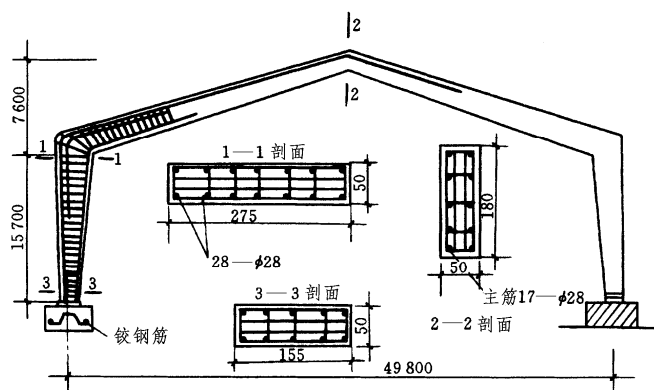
广州体育馆钢筋混凝土刚架结构 (单位: mm)
